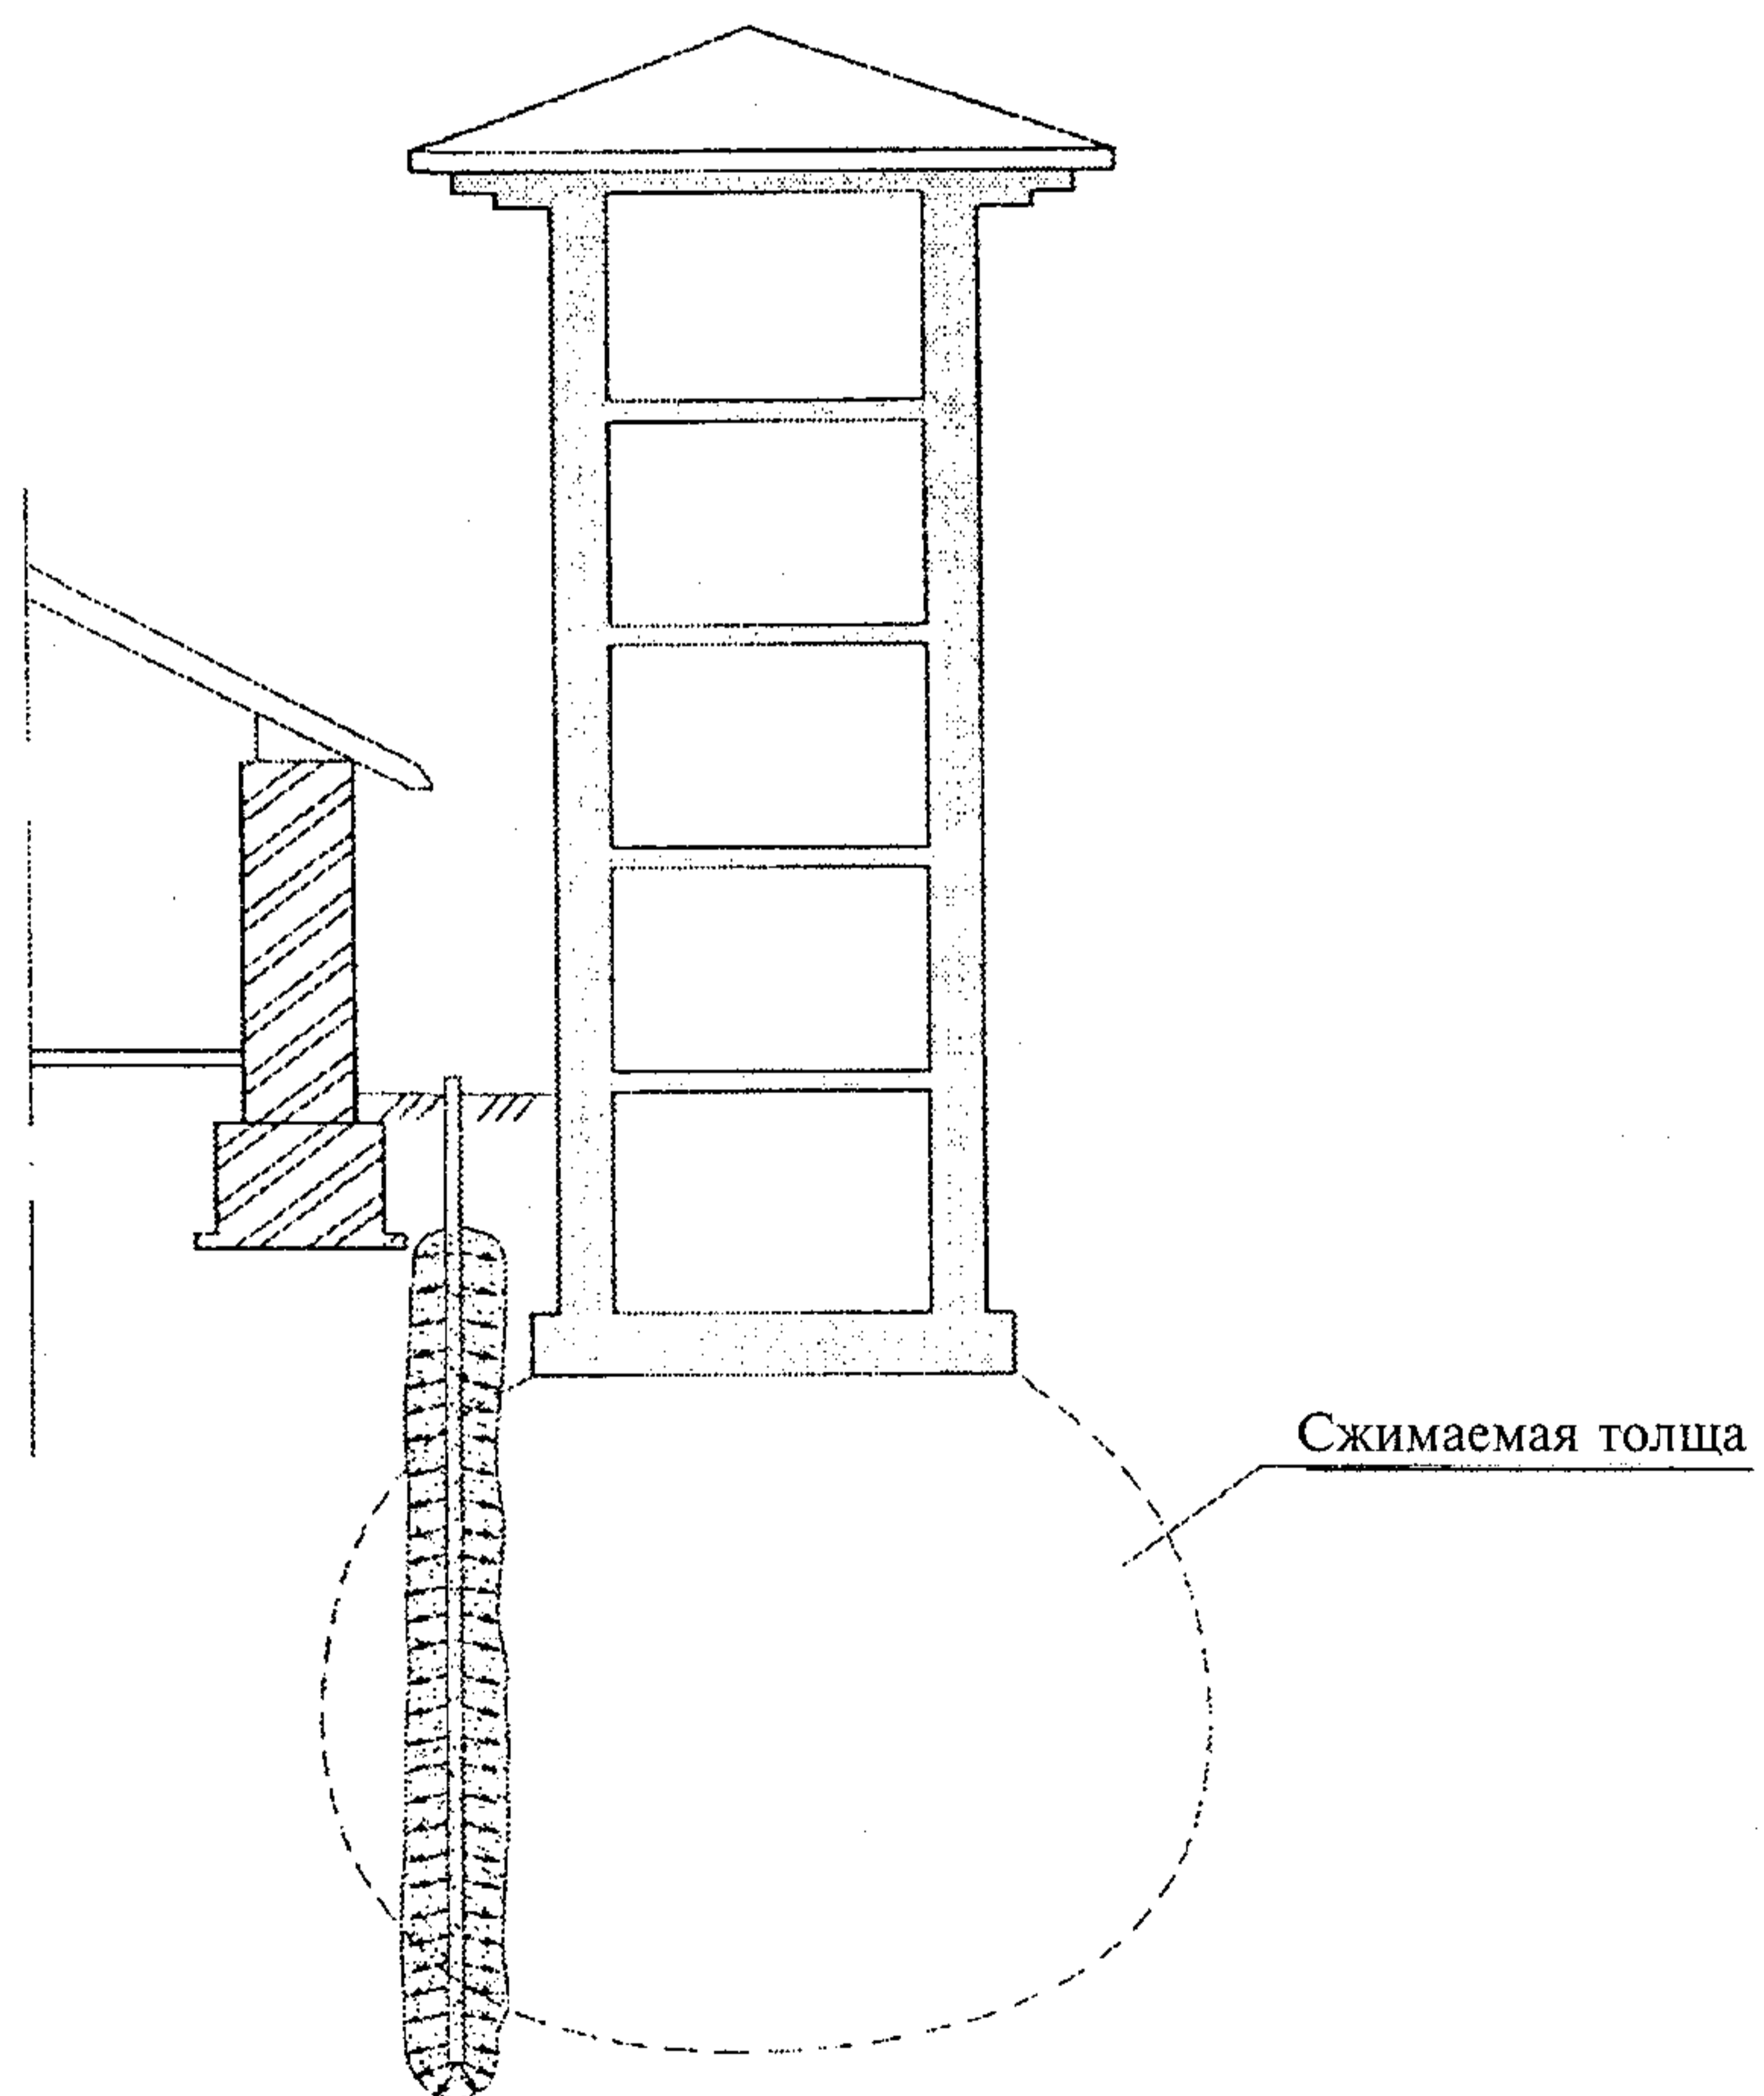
Защита фундаментов существующего здания для снижения взаимного влияния фундаментов
